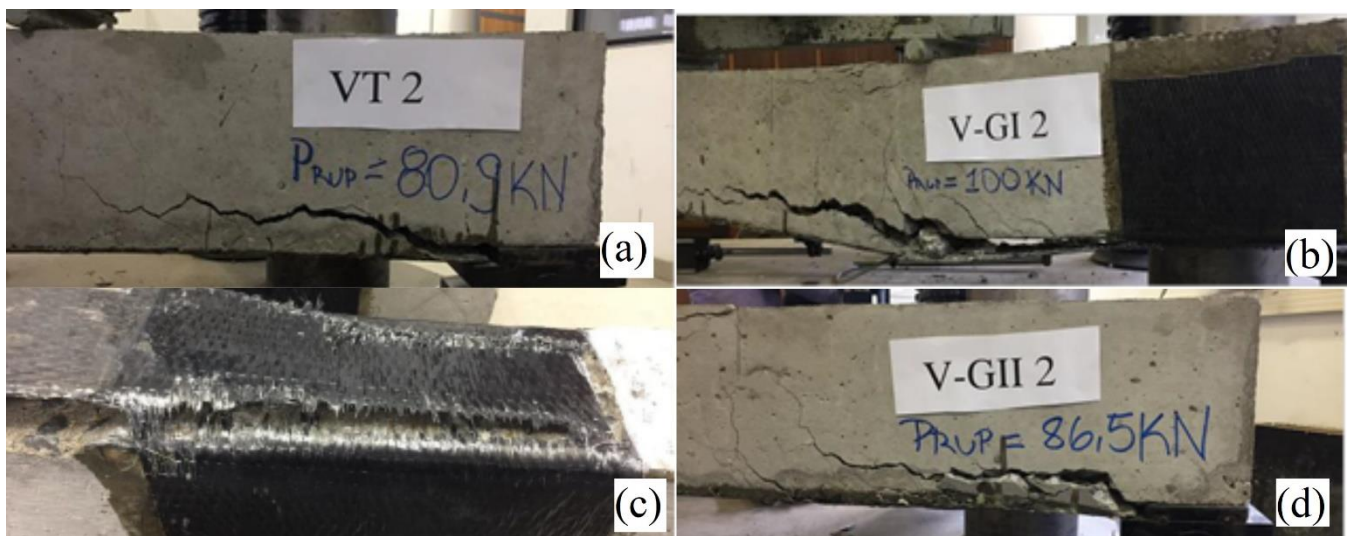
(a): Viga testemunho após ruptura; (b) Descolamento do reforço; (c) Ruptura do laço em “U”; (d) Viga do Grupo II rompida
